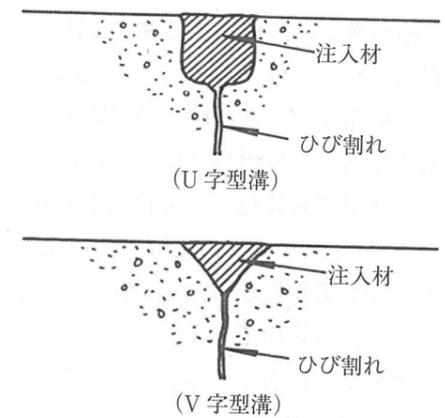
コンクリート舗装における進行性ひび割れのシール溝形状
